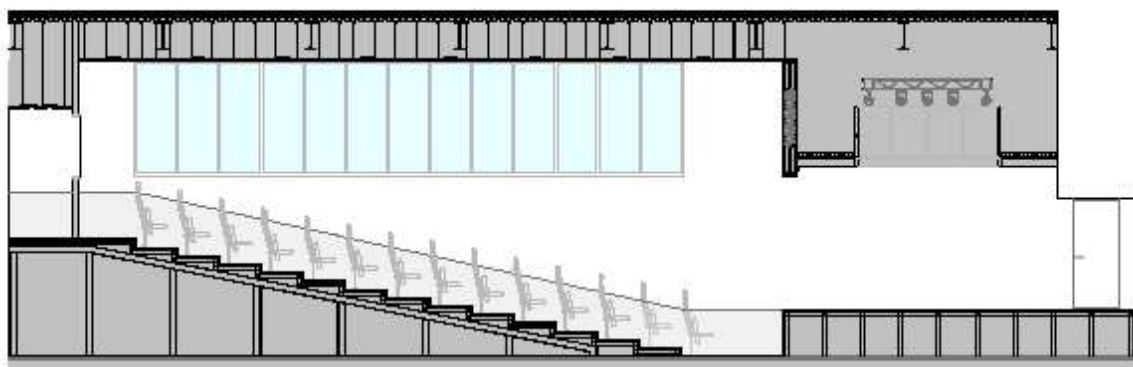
Corte longitudinal do Auditório (Fonte: Autor)
